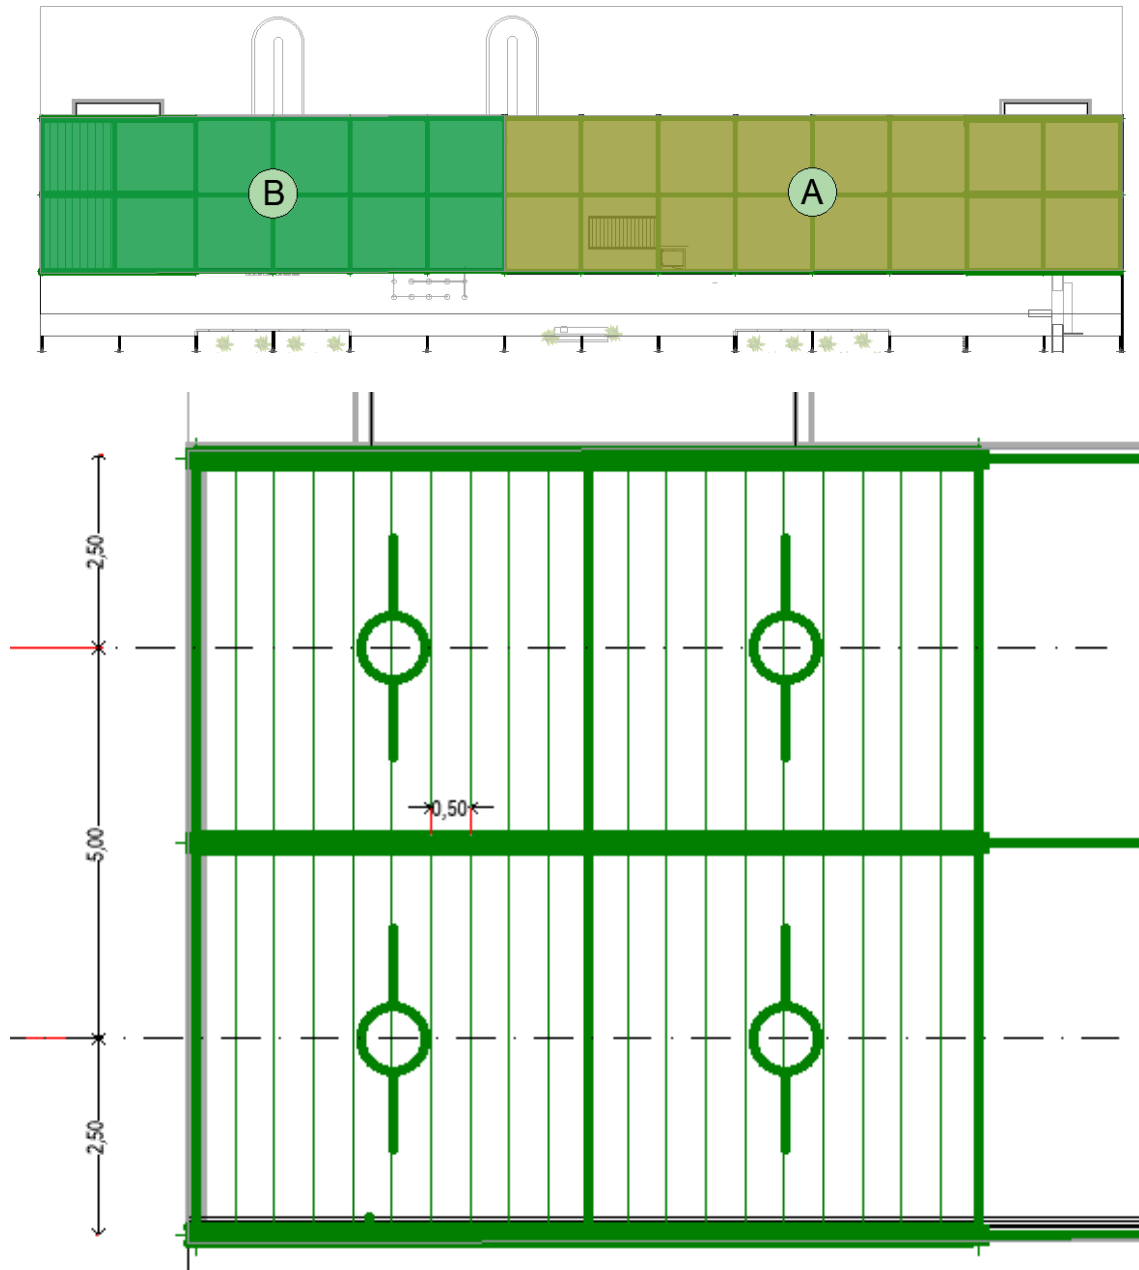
Área tributaria de la cubierta para vigas de entrepiso
